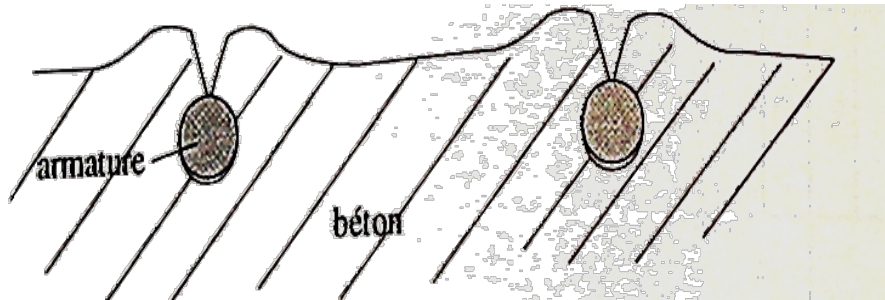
Tassement de béton bloqué par le lit supérieur d'armature
